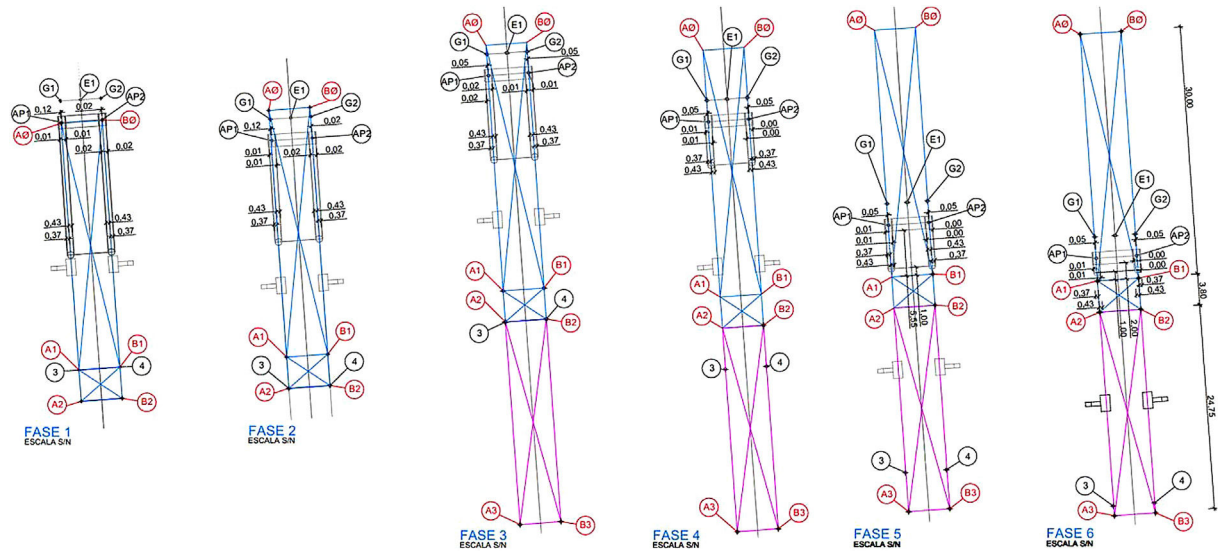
Replanteo en planta de puntos de control durante los primeros empujes.
